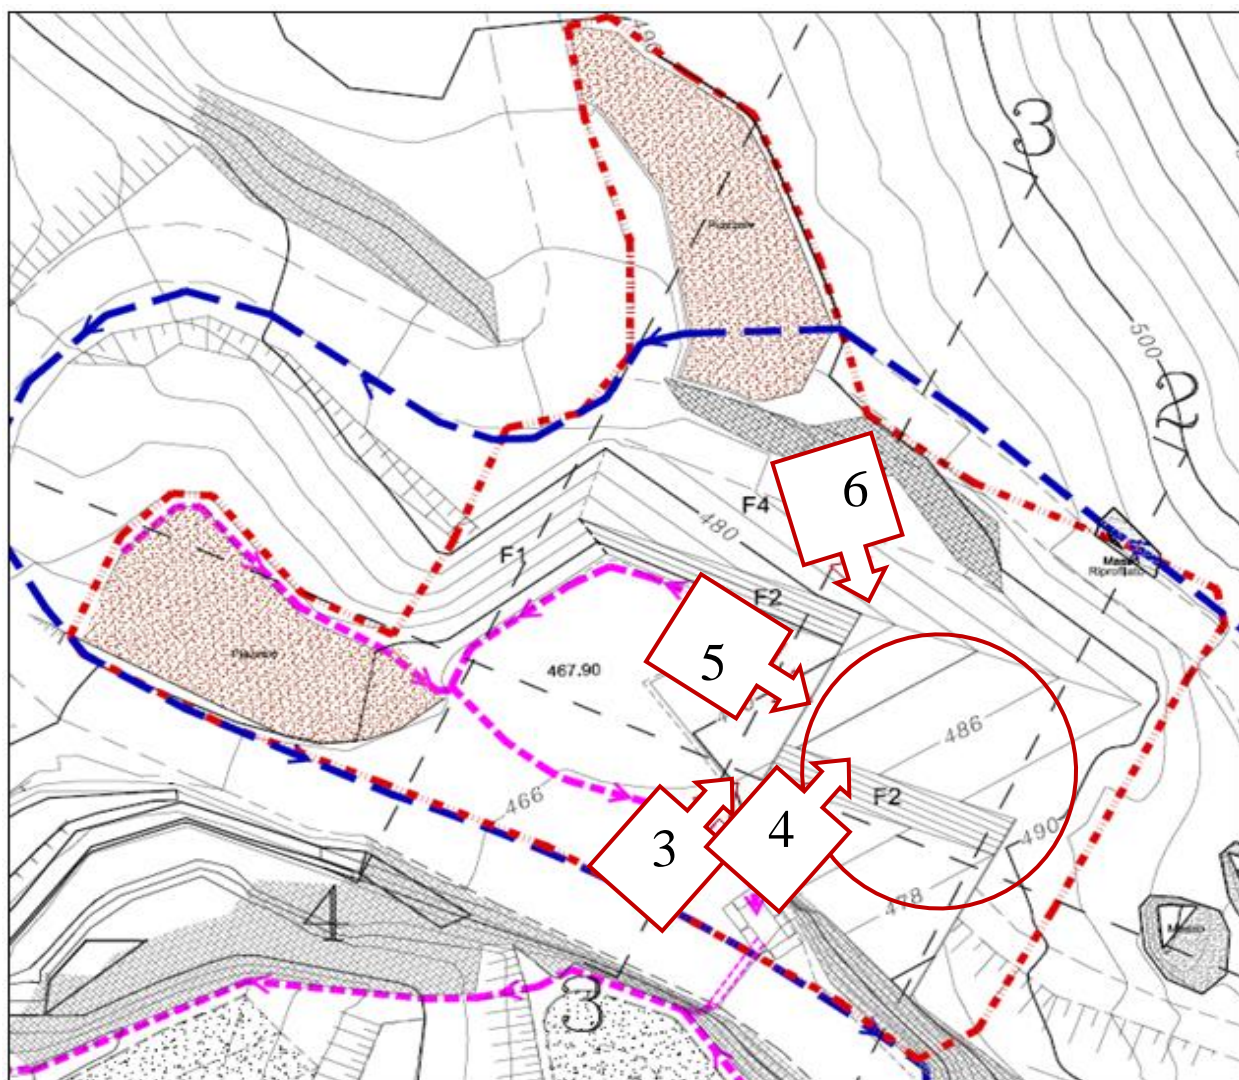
Stralcio della planimetria di progetto relativa alla prima fase di coltivazione (marzo 2016) con l'orientazione delle fotografie riportate nel seguito.
